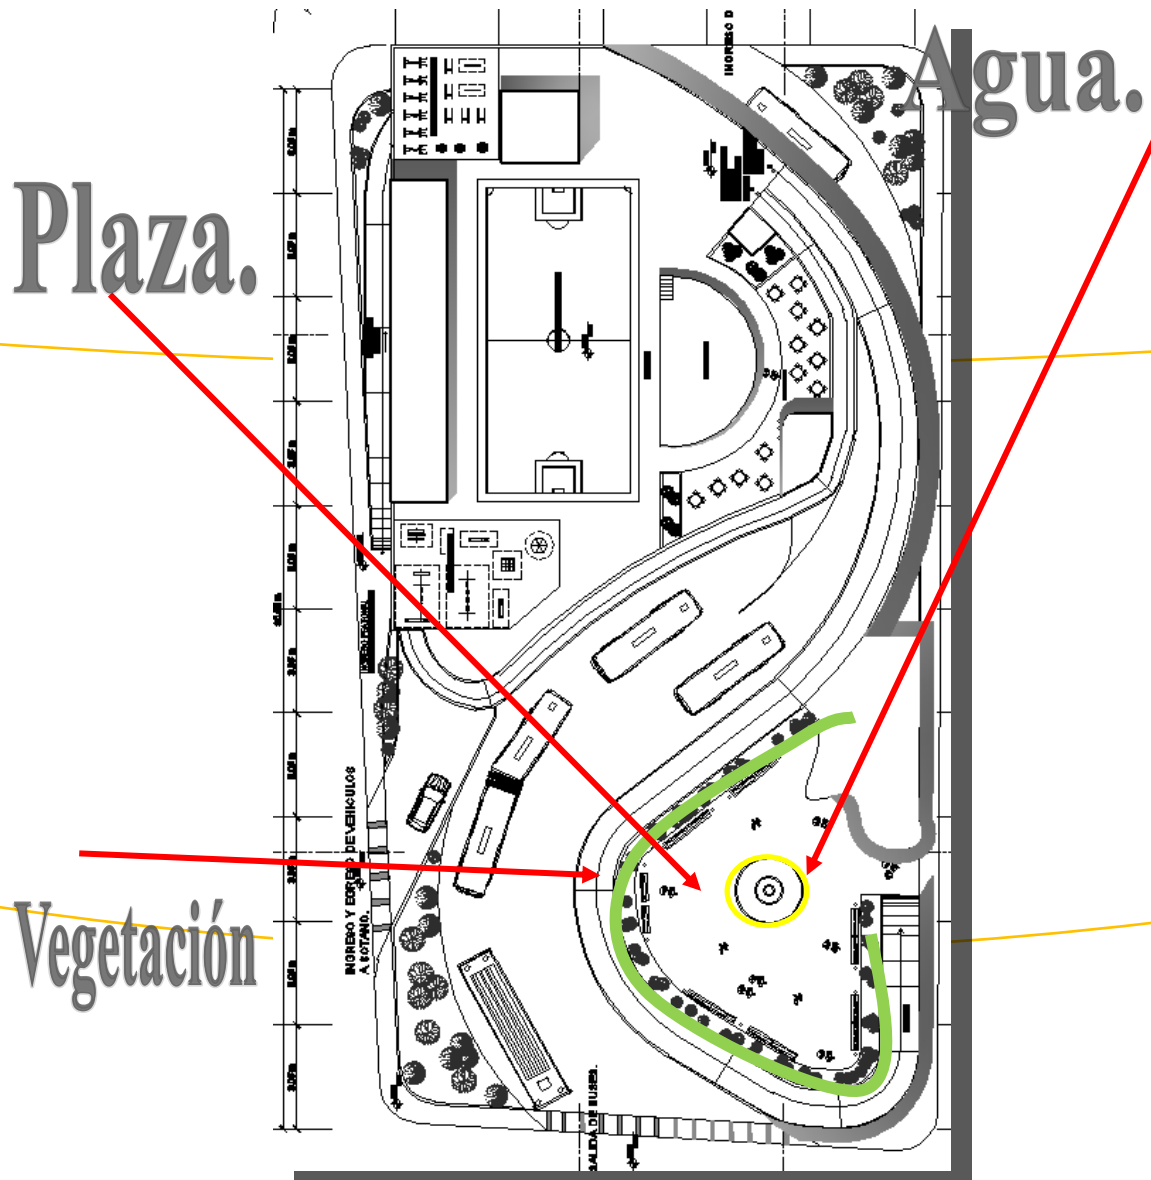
« Planta de conjunto» imagen de elaboración propia 13/09/15
